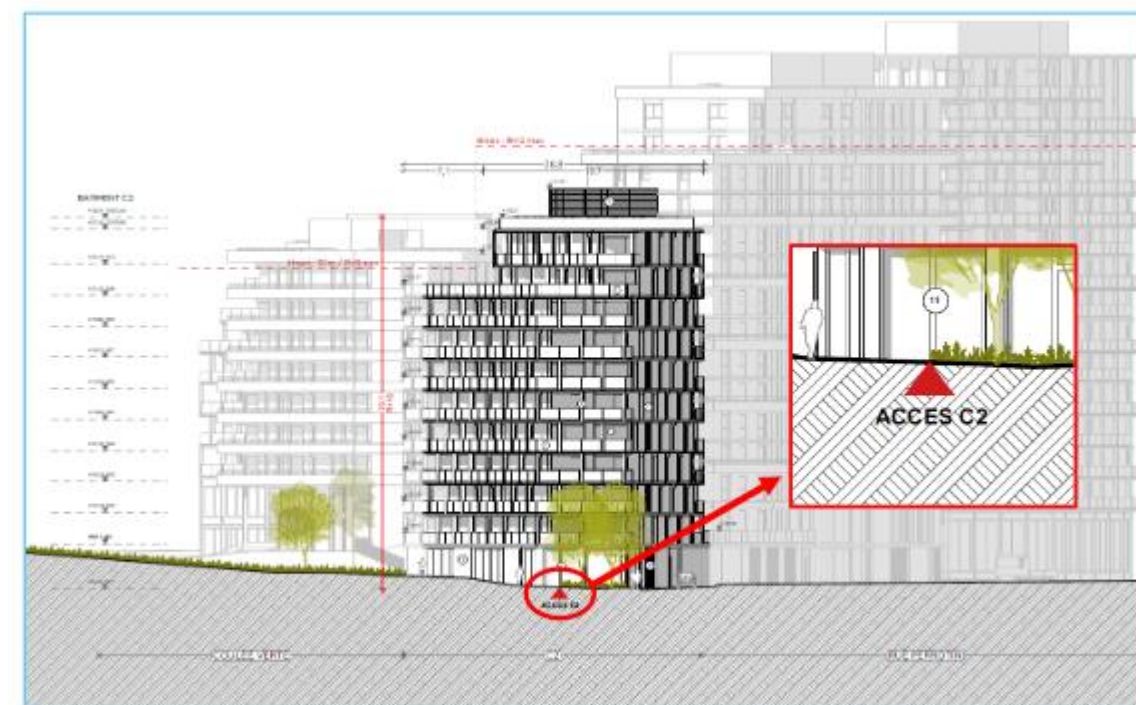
Coupe longitudinale de la façade à l'angle de la coulée verte et de la rue Perrotin (Source : PPX Architecture)
